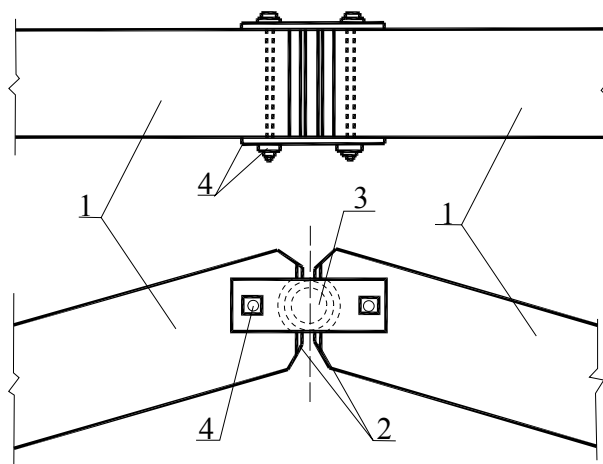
Конструкція конкового шарніра (Запорізька філія к. Укрколгоспроект):1-ригель піврами; 2- закладні деталі; 3-труба М89 з бетоном В15; 4-накладна деталь з болтами
